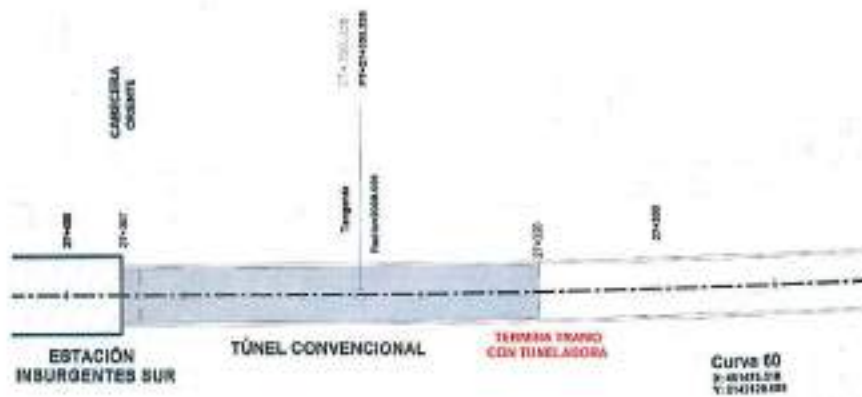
Planta de localización del primer tramo de túnel excavado con el método convencional
